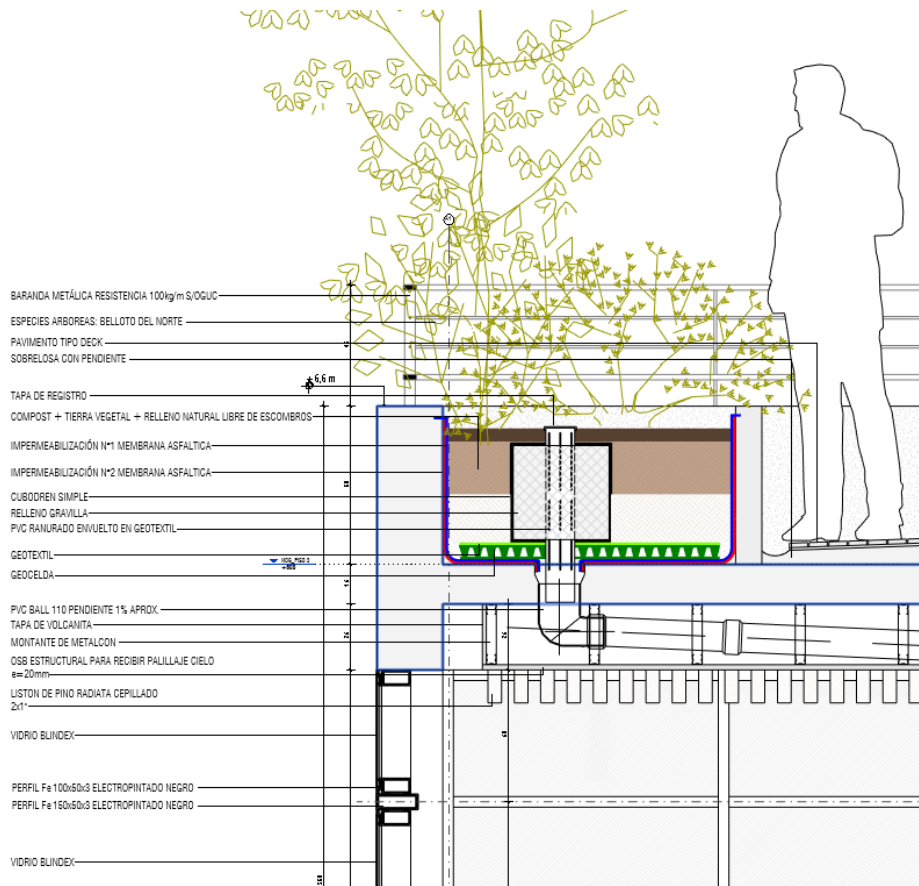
vista parcial, escantillón constructivo, ver detalle en plano “escantillón constructivo centro cultural y equipamiento residencial”
